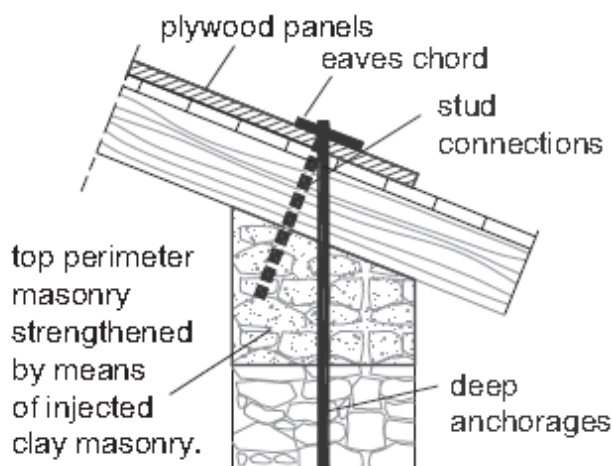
Pormenorização da ancoragem – adaptado de (Giuriani e Marini, 2008)
